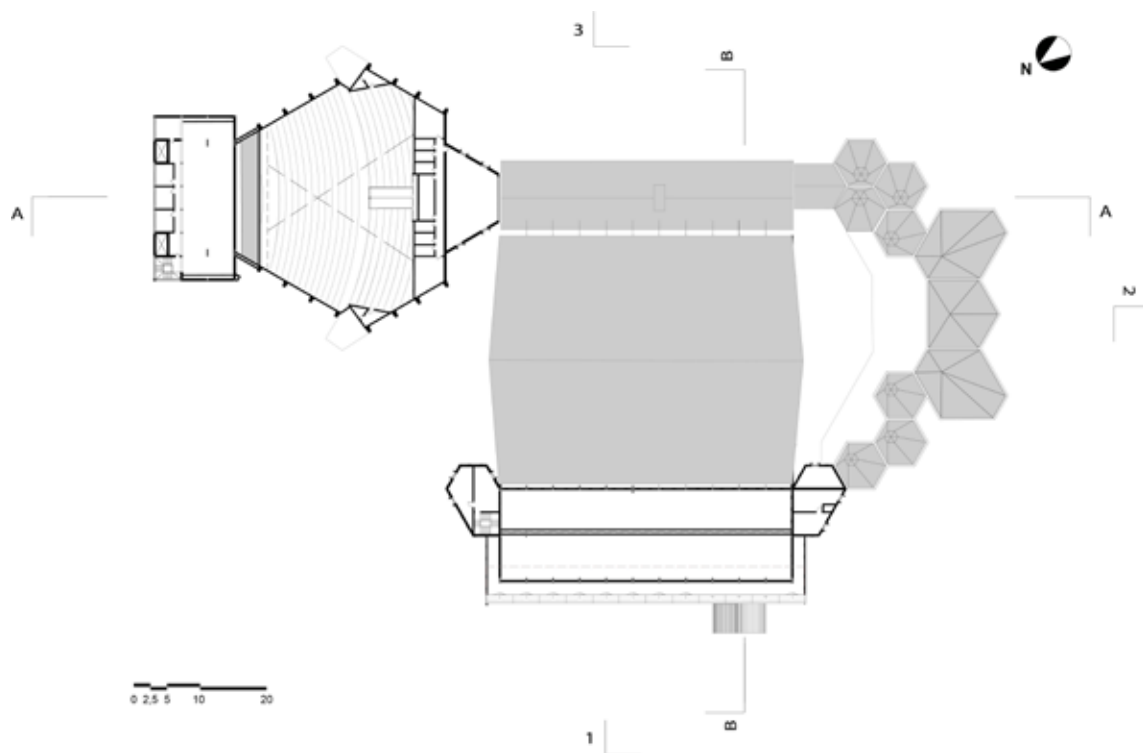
Planta do 2º pavimento do Centro de Convenções do Ceará (1973), 1ª fase
